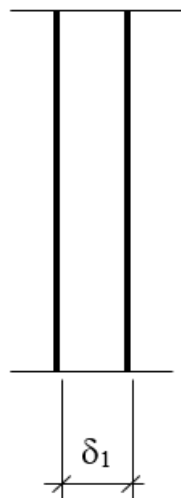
Розрахункова схема вертикальної конструкції
